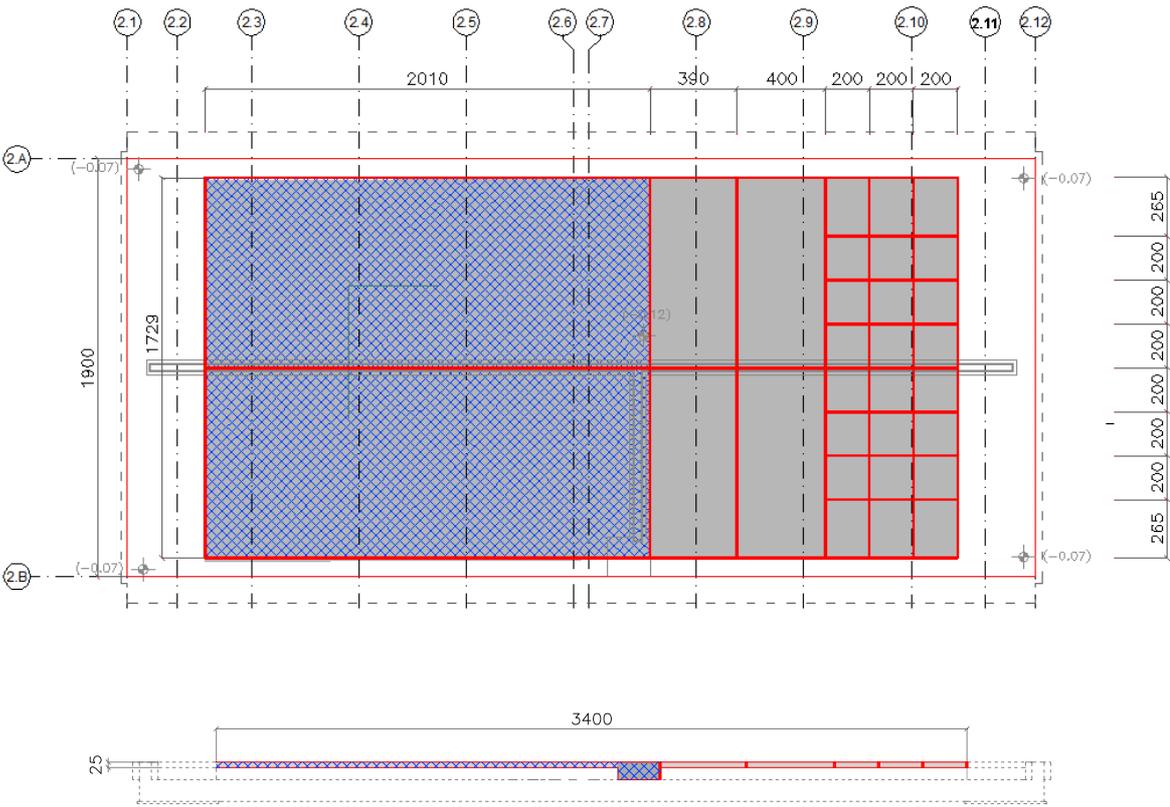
Taglio e rimozione piastra di fondazione (Pianta e sezione)
